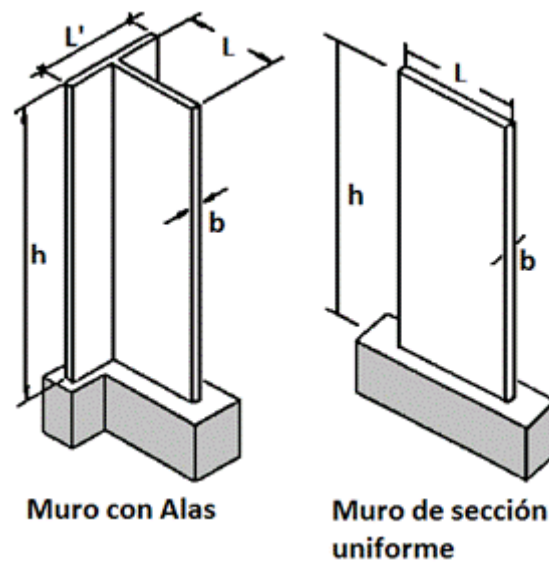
a) Muros con diferentes vistas en planta.²⁶
